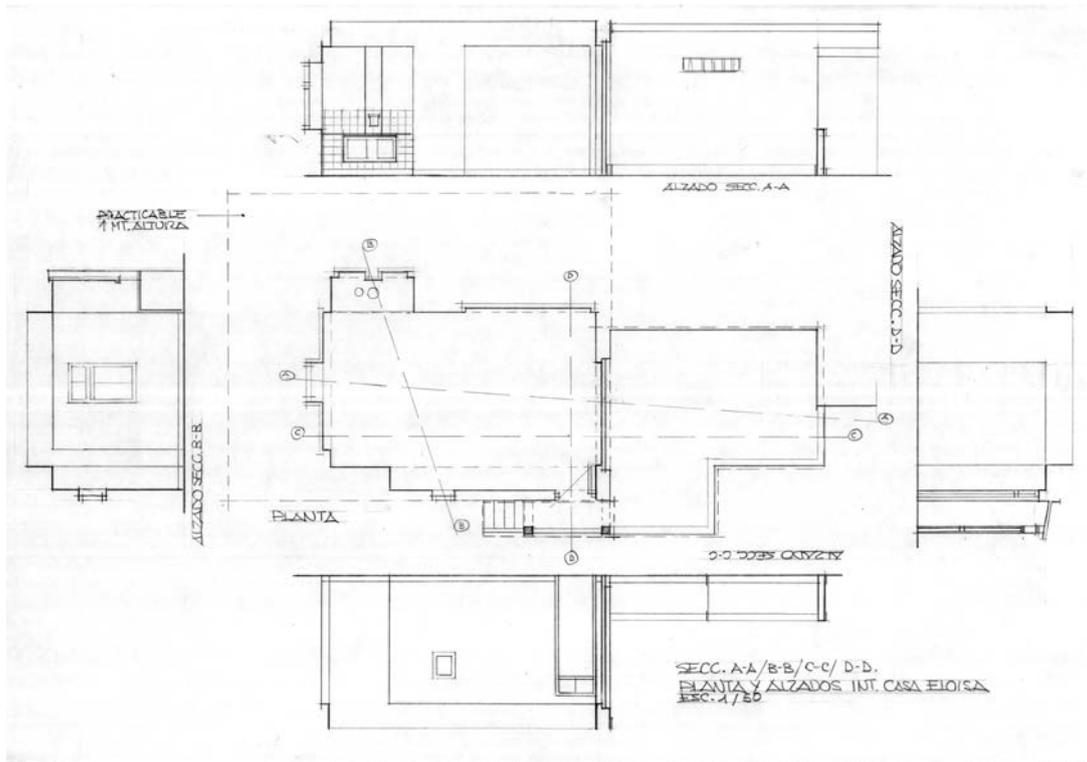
Boceto técnico de la planta y alzados para la casa de Eloísa.
